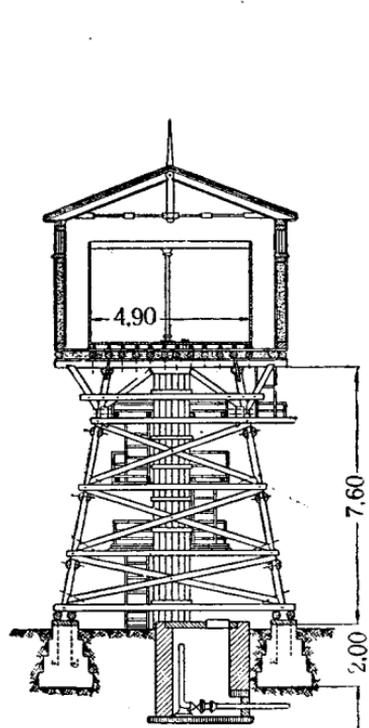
Конструкция железобетонного водохранилища на 30 м³.
